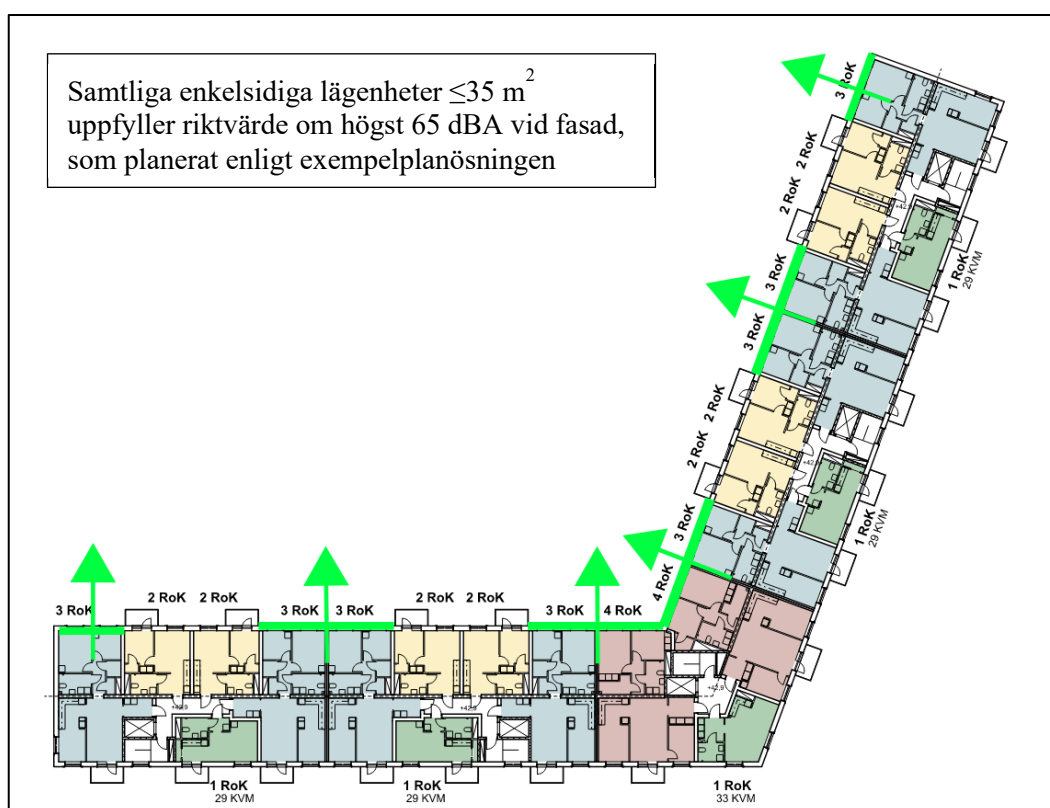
Exempel på planlösning för plan 10 (entrévaåning).
